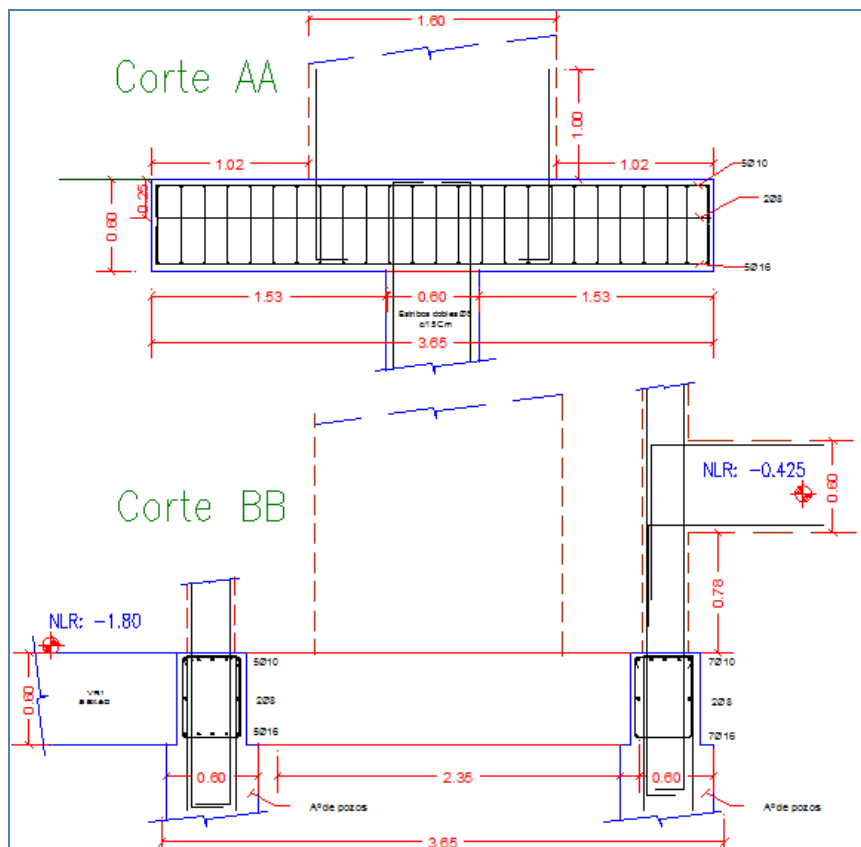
Detalles de la vinculación entre cabezal, pilotes y vigas riostras.
